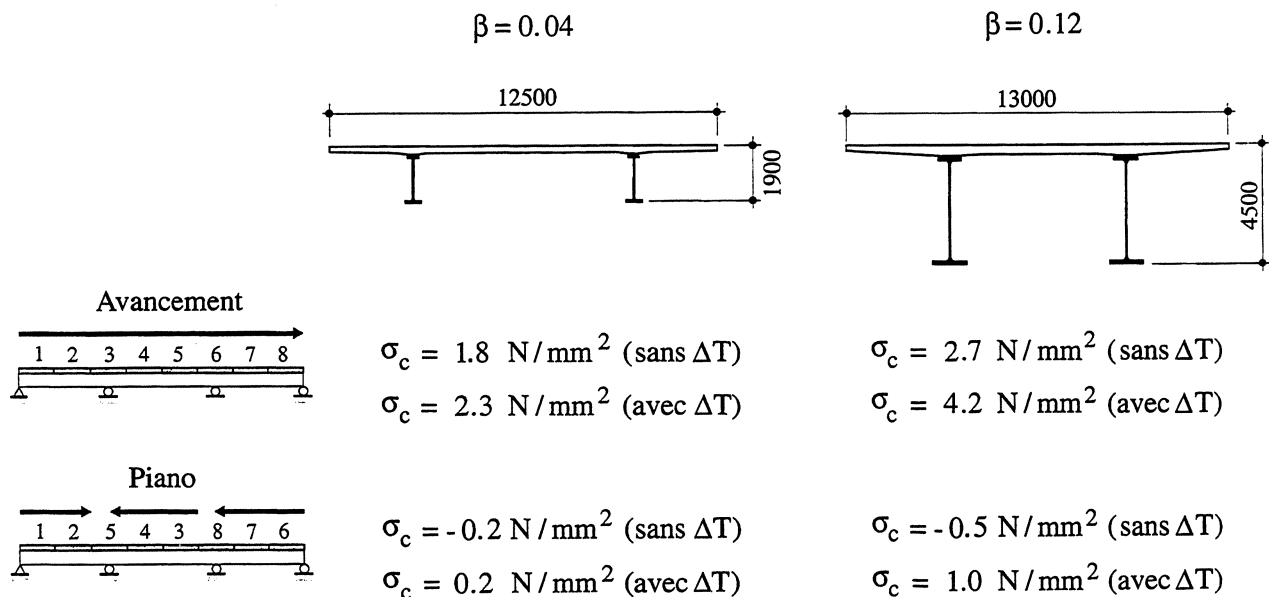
Contraintes de traction dans la dalle, au droit des appuis intermédiaires, dues à la mise en place du béton
